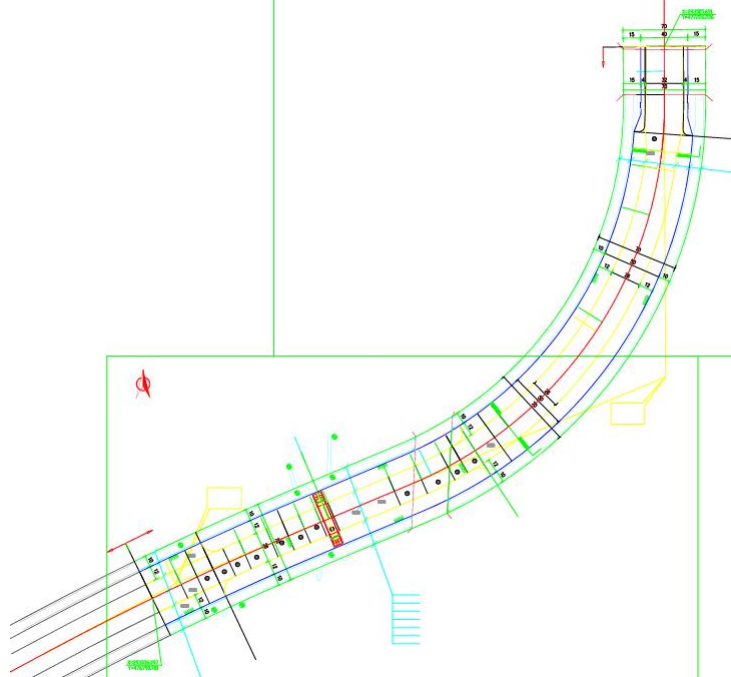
工程平面布置图 (2+355.513~3+057.188 段)
